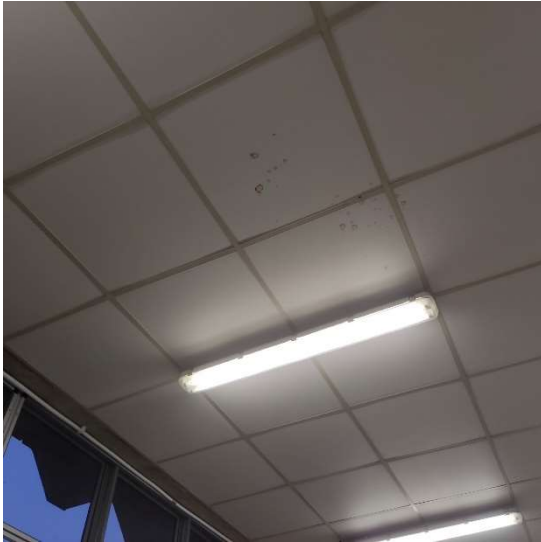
Teto da Planta Piloto de Produtos Vegetais e Bebidas
